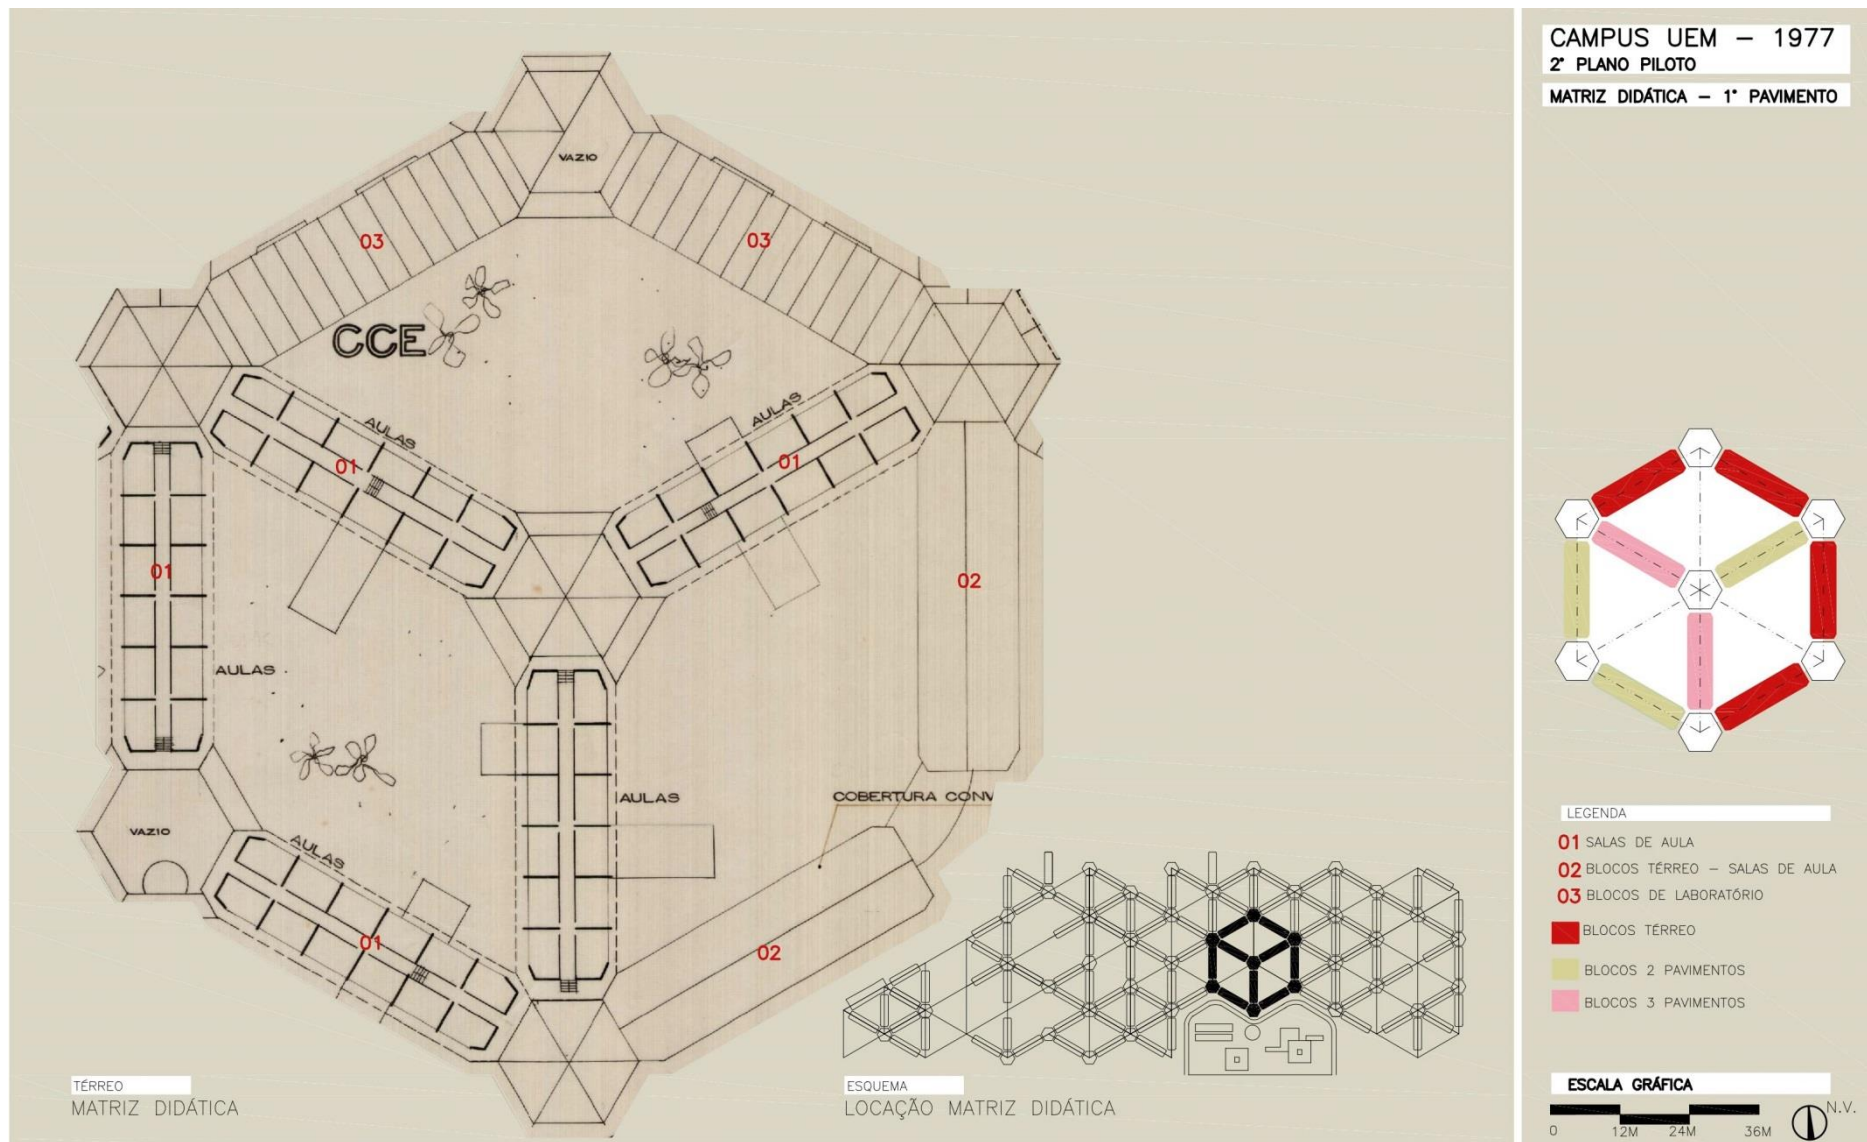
Matriz Didática Primeiro Pavimento. Fonte: Mapa Base Prancha 09 – Plano Piloto 1977. Disponível na DOP/PTO. Elaboração Renan Avanci.
